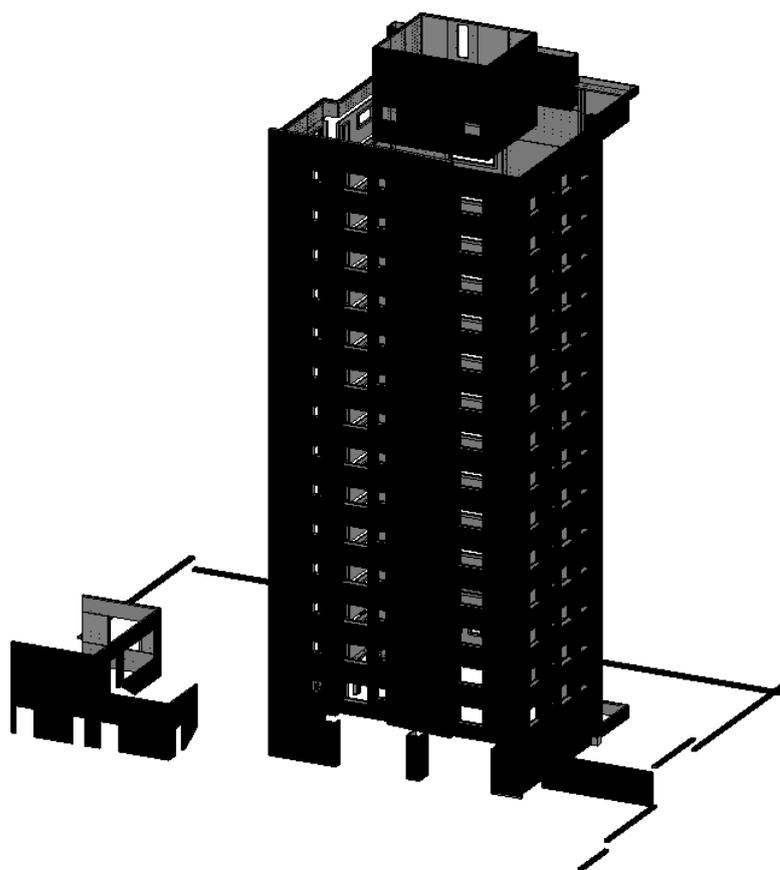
Parte referente ao tipo do projeto estrutural – EST Tipo
